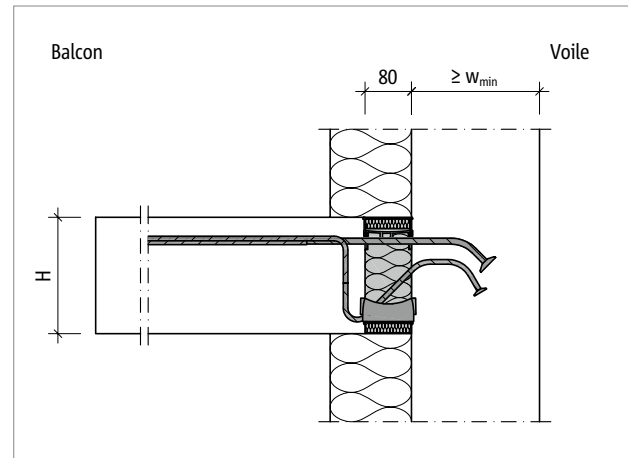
Schöck Isokorb® T type K-O : raccordement mural vers le bas avec isolation extérieure
